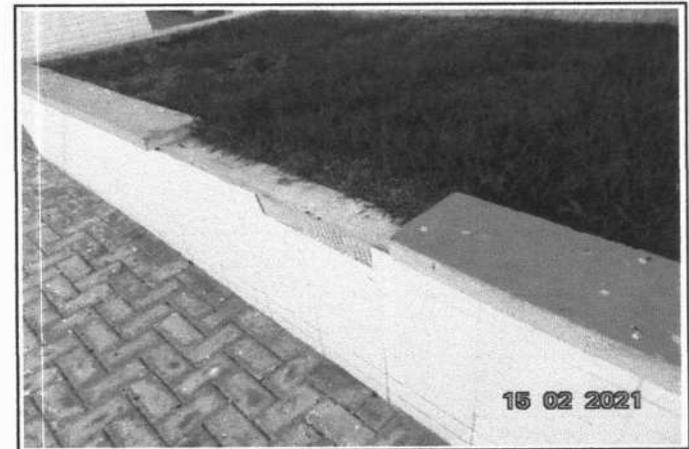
SUBSTITUIÇÃO DE CHAPINS
